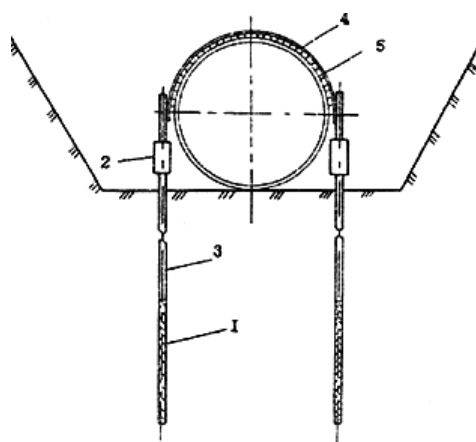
Схема конструкции стержневого анкерного устройства: 1 - стержневой анкер; 2 - компенсатор; 3 - тяга; 4 - силовой пояс; 5 – футеровочный мат
